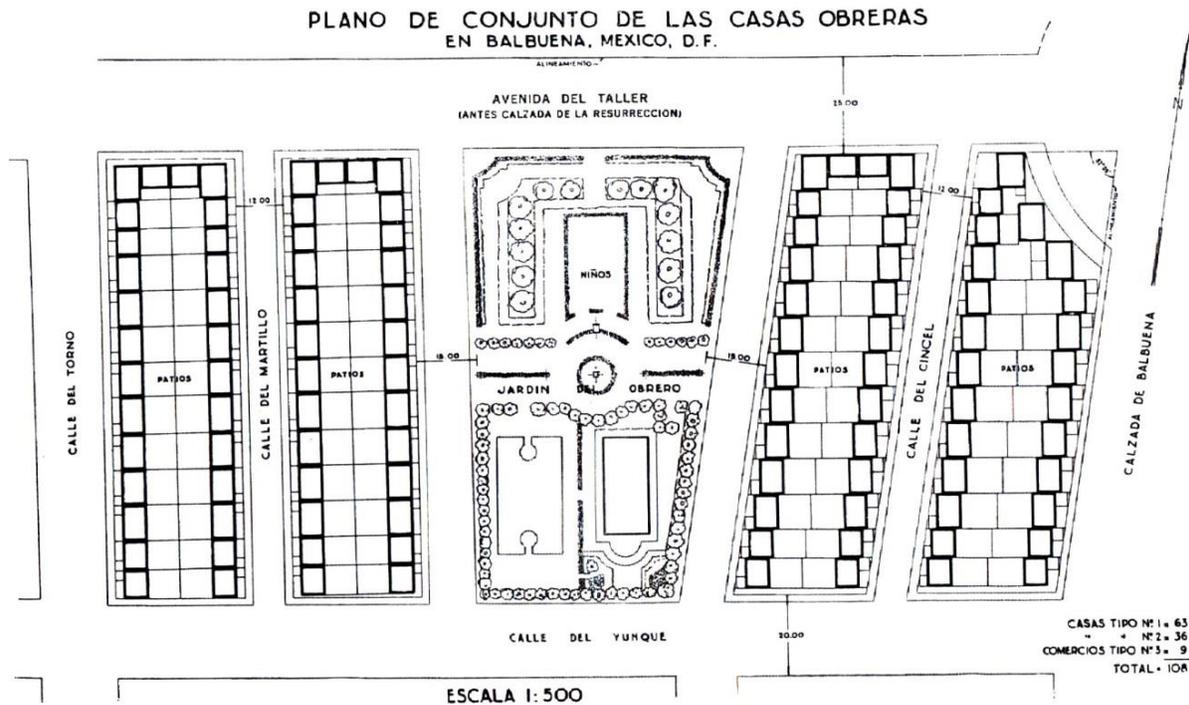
Plano de conjunto de la Colonia Obrera.
